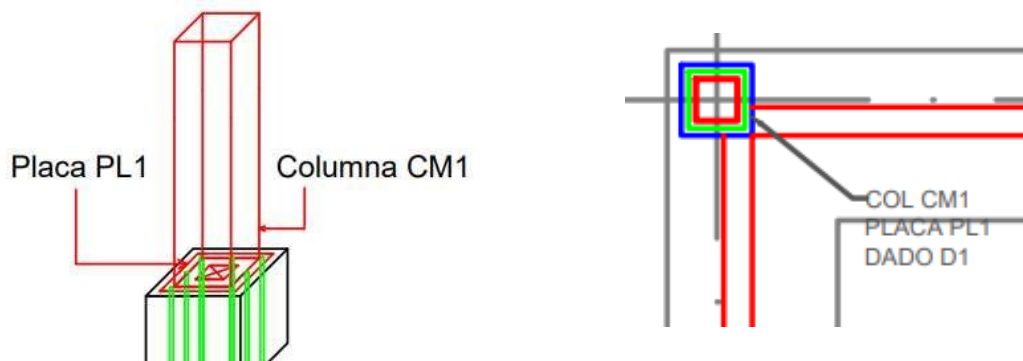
Placa metálica con dado de hormigón (*Redwood & Paredes, 2023*)
